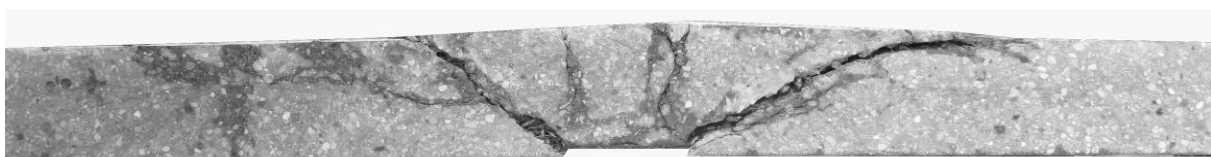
Fissuration à plusieurs niveaux de charge et fissures internes de la dalle B3-01.
